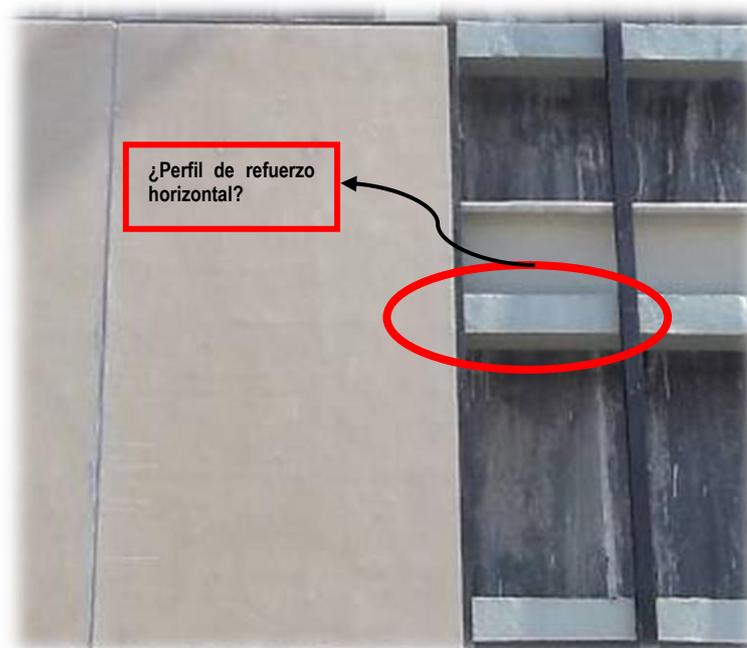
Detalle falta instalación perfil de refuerzo horizontal.
